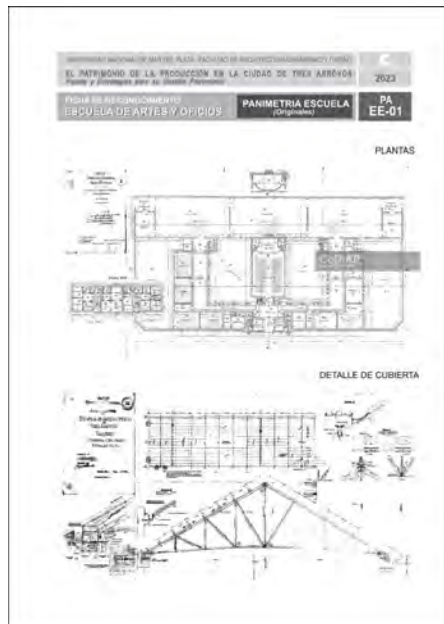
y 11 - Planos de Arquitectura (PA): Escuela de Artes y Oficios (documentación Histórica). Fuente: CeDIAP Sistematización de planos de obra y detalles constructivos.
